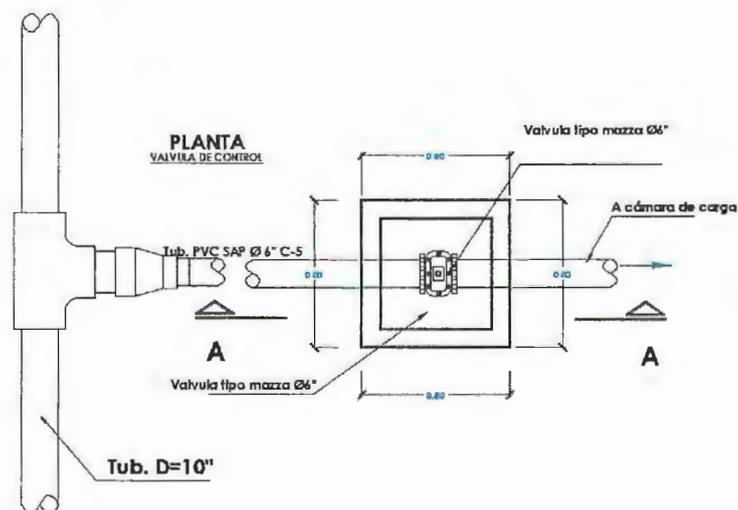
Sección Típica en Planta de la Cámara de Válvulas
